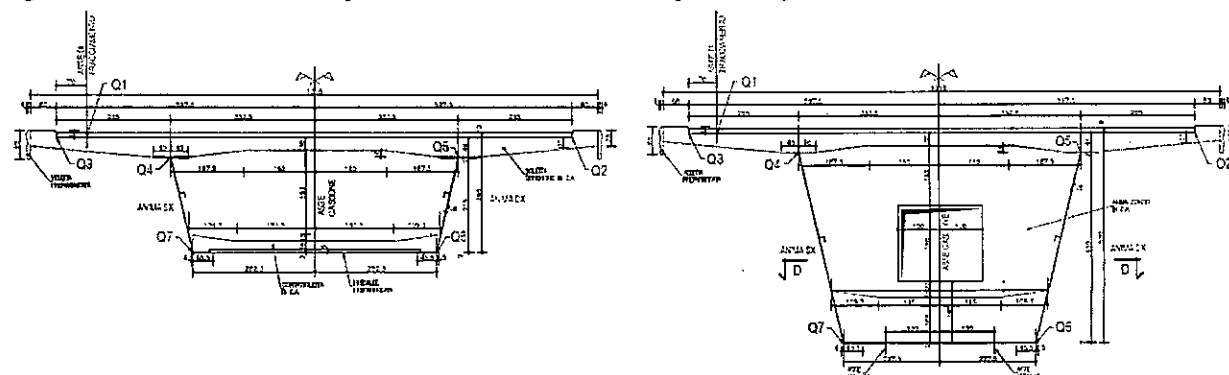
Sezione trasversale impalcato in mezzeria e in asse pila - Progetto Esecutivo
